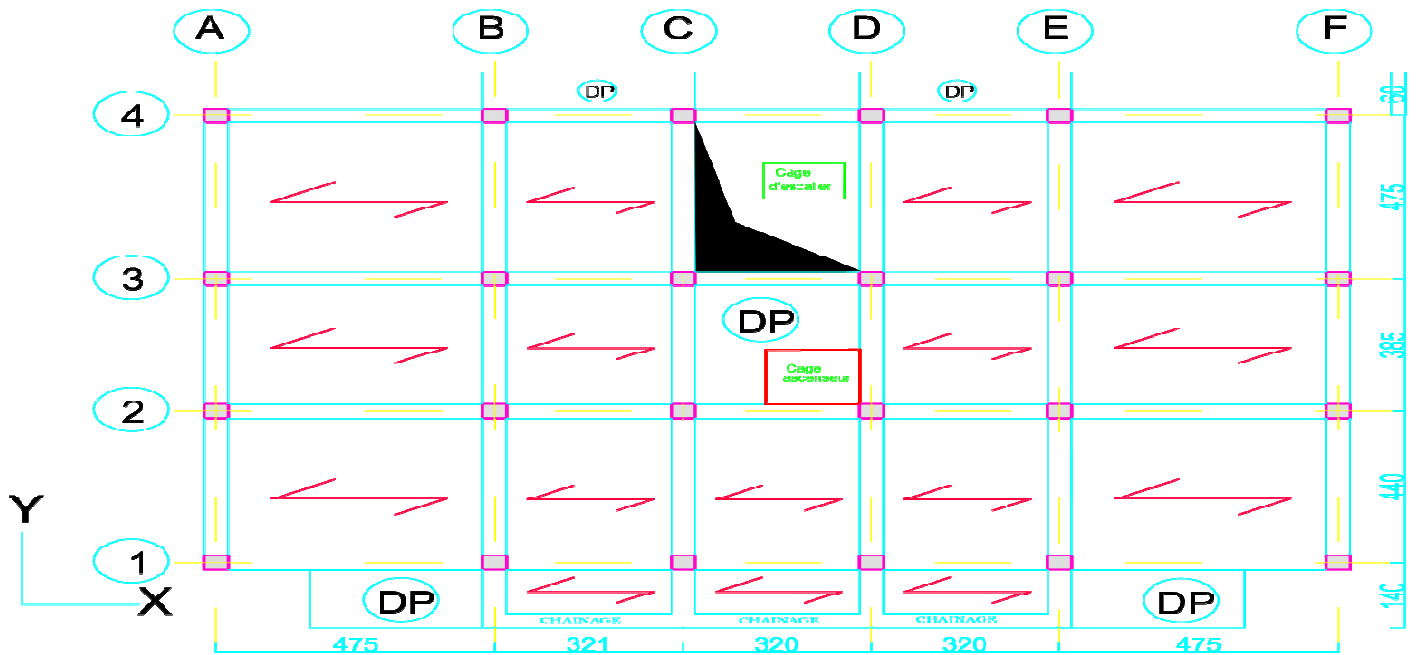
schéma montrons la disposition des poutrelles dans l'étage courant.
